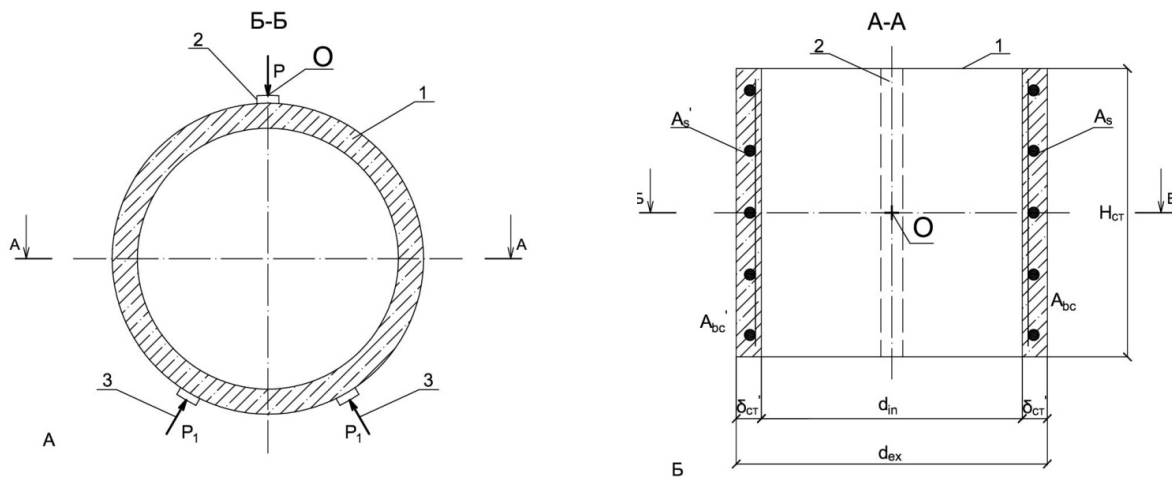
Схема испытания стенового кольца (А); схема к расчету прочности центрально-сжатого железобетонного элемента прямоугольного сечения А-А с симметричной арматурой $A_s = A'_s$ (Б): 1 – стеновое кольцо; 2 – упорная траверса; 3 – реакция опоры; 4 – упорная траверса; $\delta_{\text{ст}}$ и $H_{\text{ст}}$ – толщина и высота стенового кольца; b и h – ширина и высота прямоугольного сечения; d_{in} и d_{ex} – внутренний и наружный диаметр стенового кольца; A_s и A'_s – площадь арматуры, мм²; A_{bc} и A'_{bc} – рабочая площадь сжатого бетона, мм²; P – контрольная разрушающая нагрузка по прочности, кН; O – точка приложения нагрузки на траверсу
